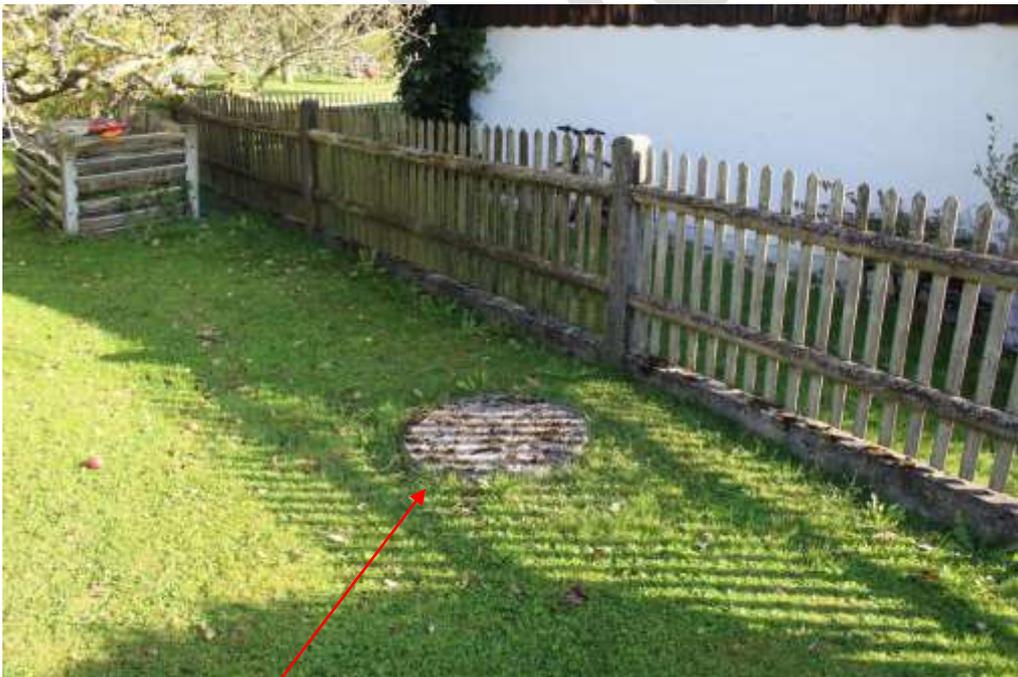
Gruben-/Schachtabdeckung im nordöstlichen Grundstücksbereich
